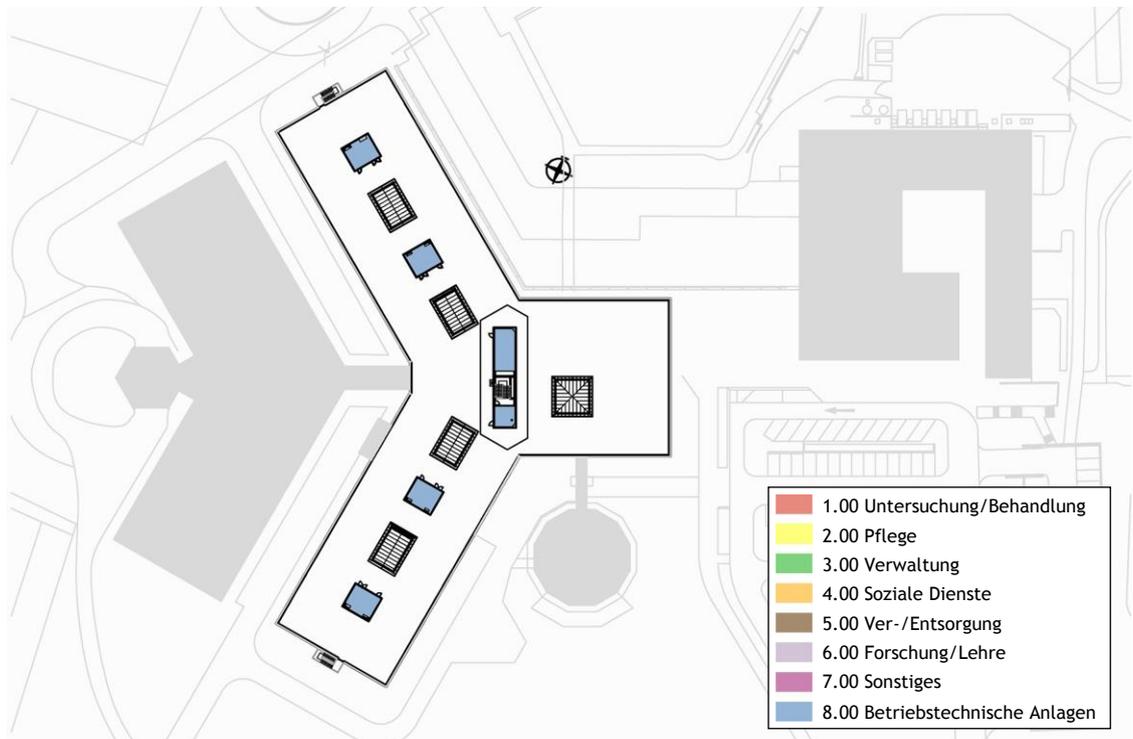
Bestandsflächen nach DIN 13080 - 4.Obergeschoss
